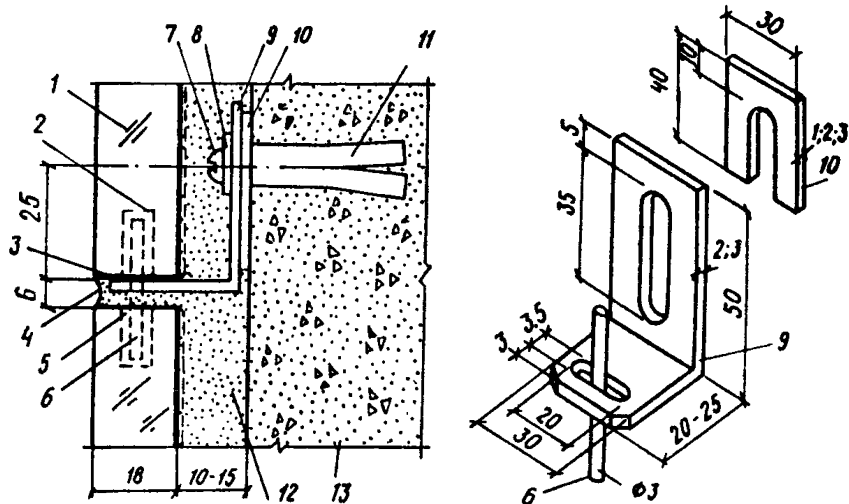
Пример крепления плит из сиграна с круглыми отверстиями на торцевой грани
